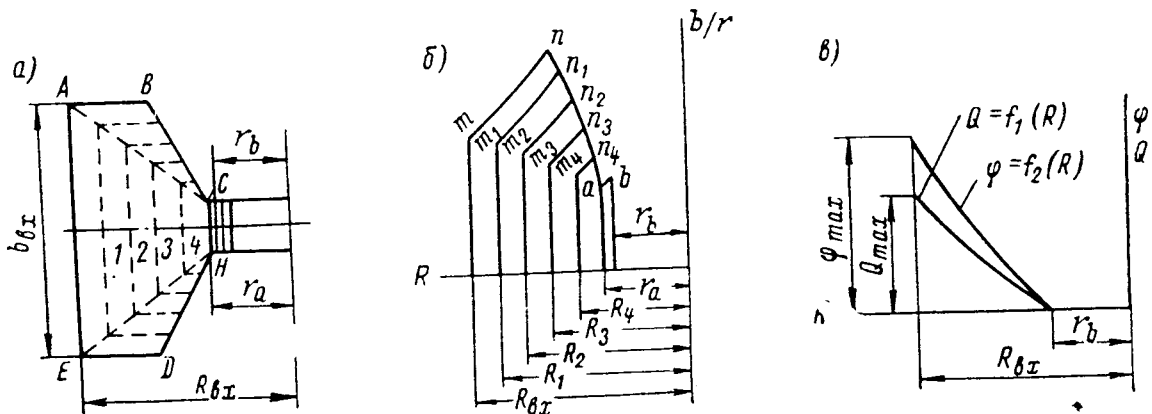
К расчету размеров бетонной спиральной камеры таврового сечения
